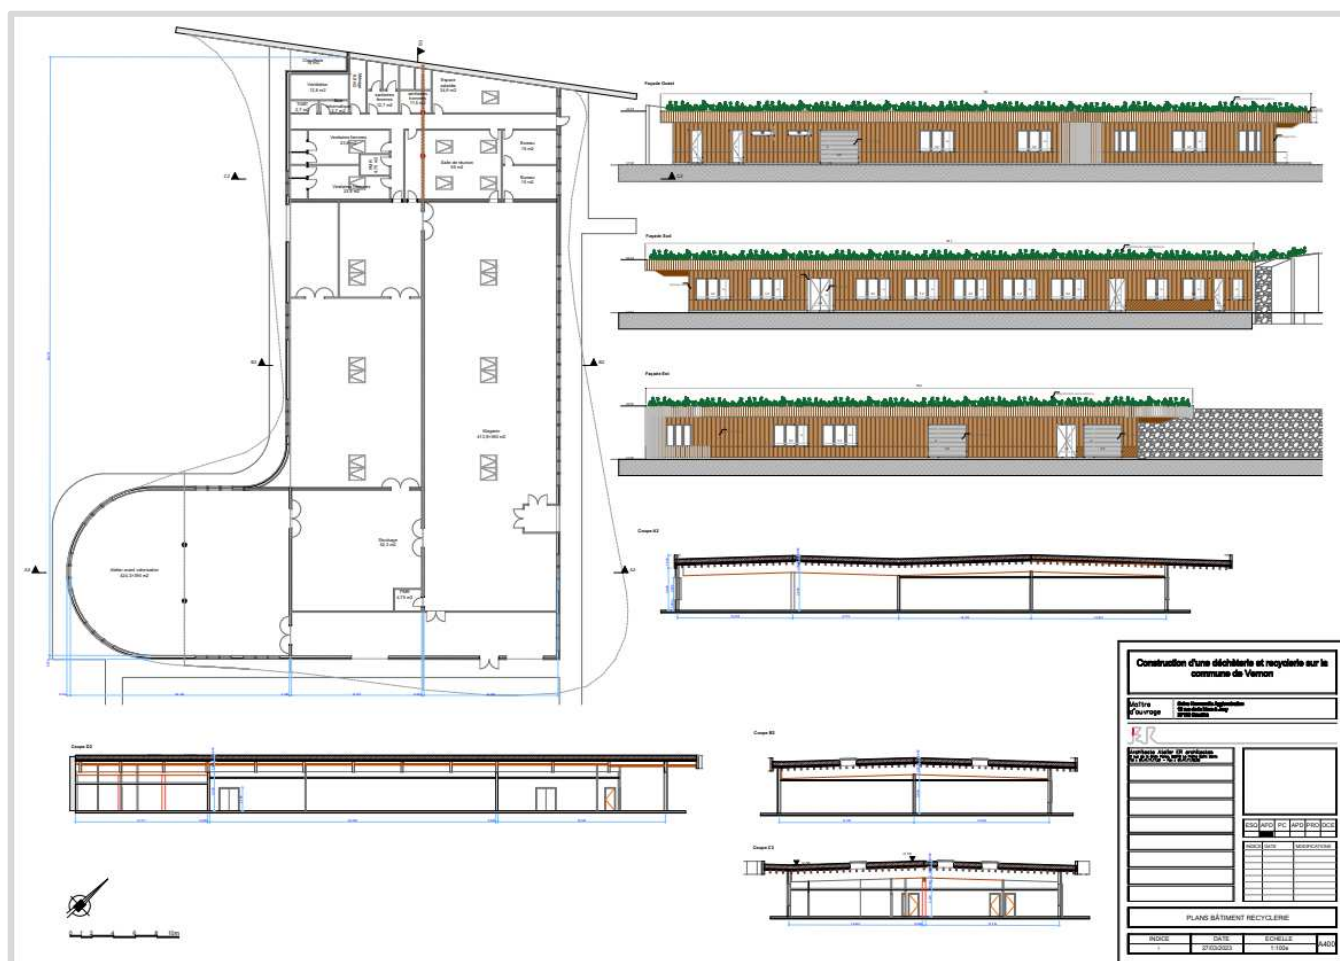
plan du bâtiment de la recyclerie (source Architecte ER).
